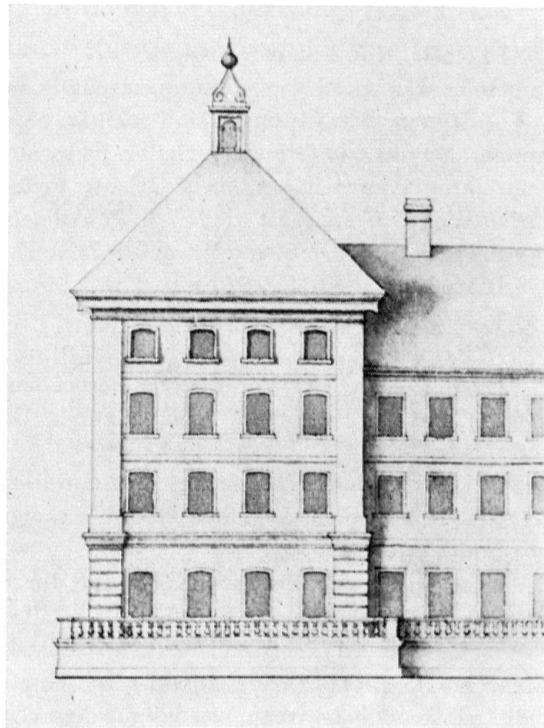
Lindau, Damenstift. Entwurf J. M. Beers, 1729. Stiftsgebäude (Detail)
